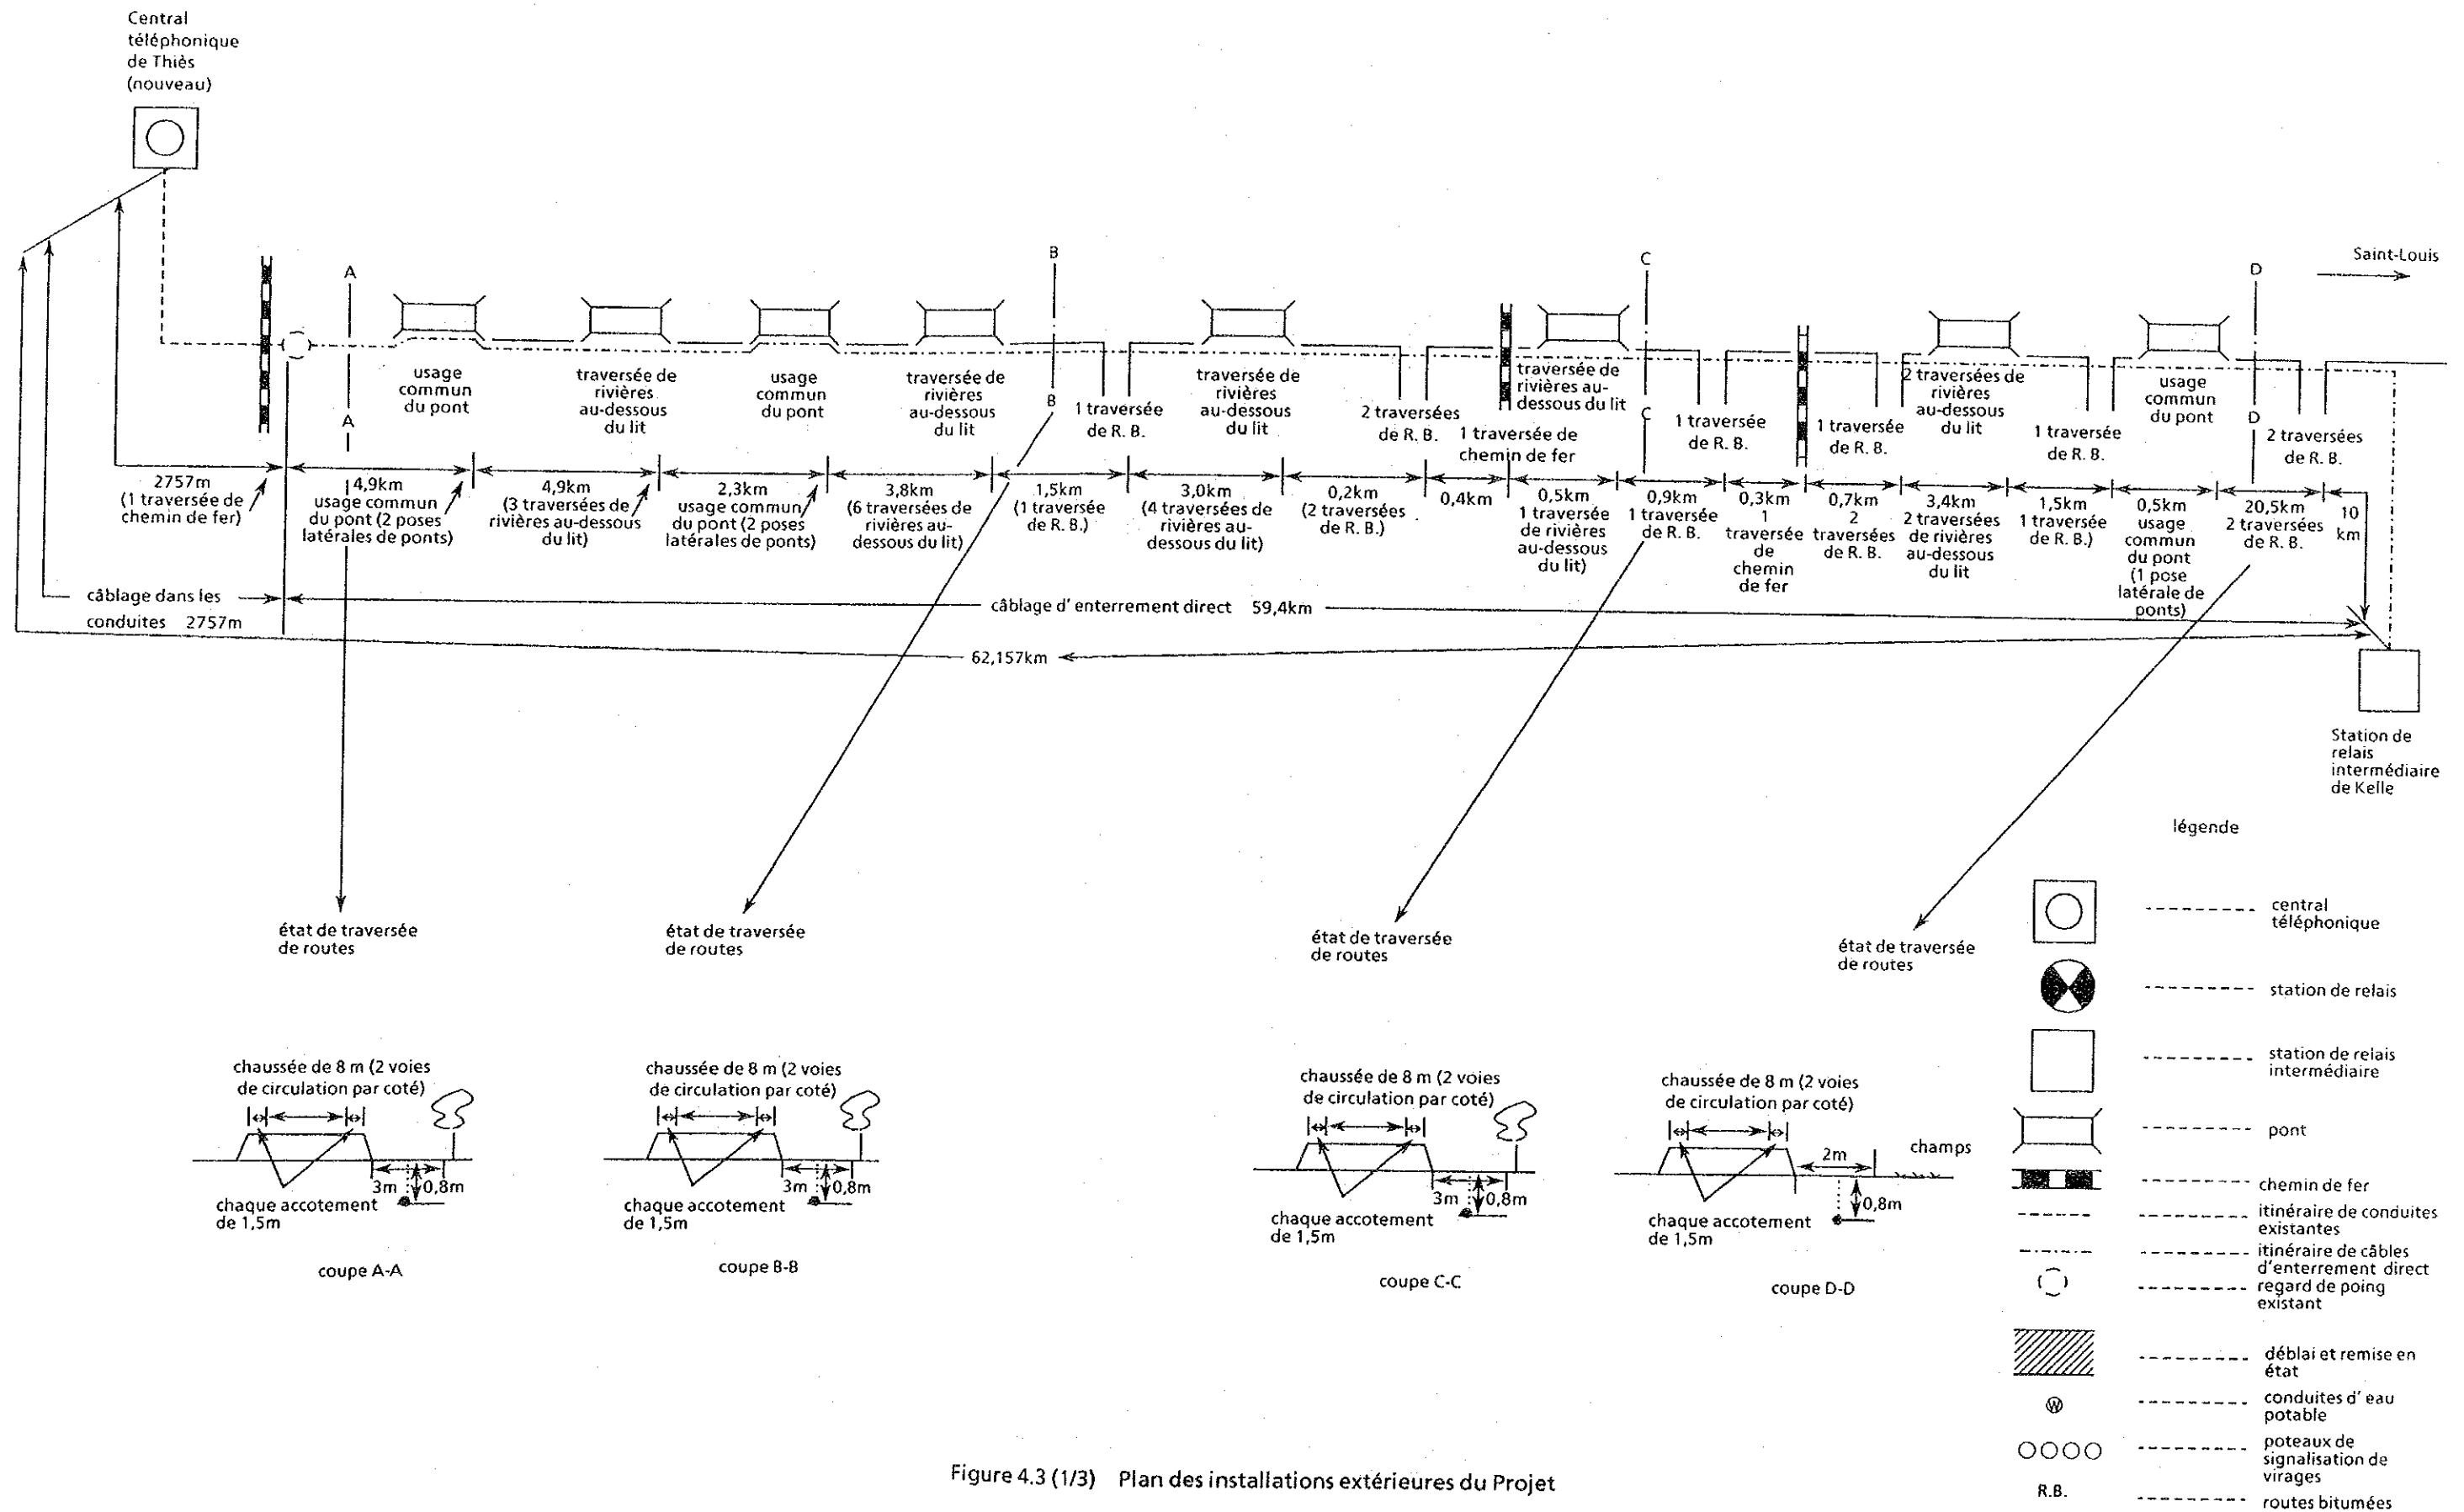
(1/3) Plan des installations extérieures du Projet
